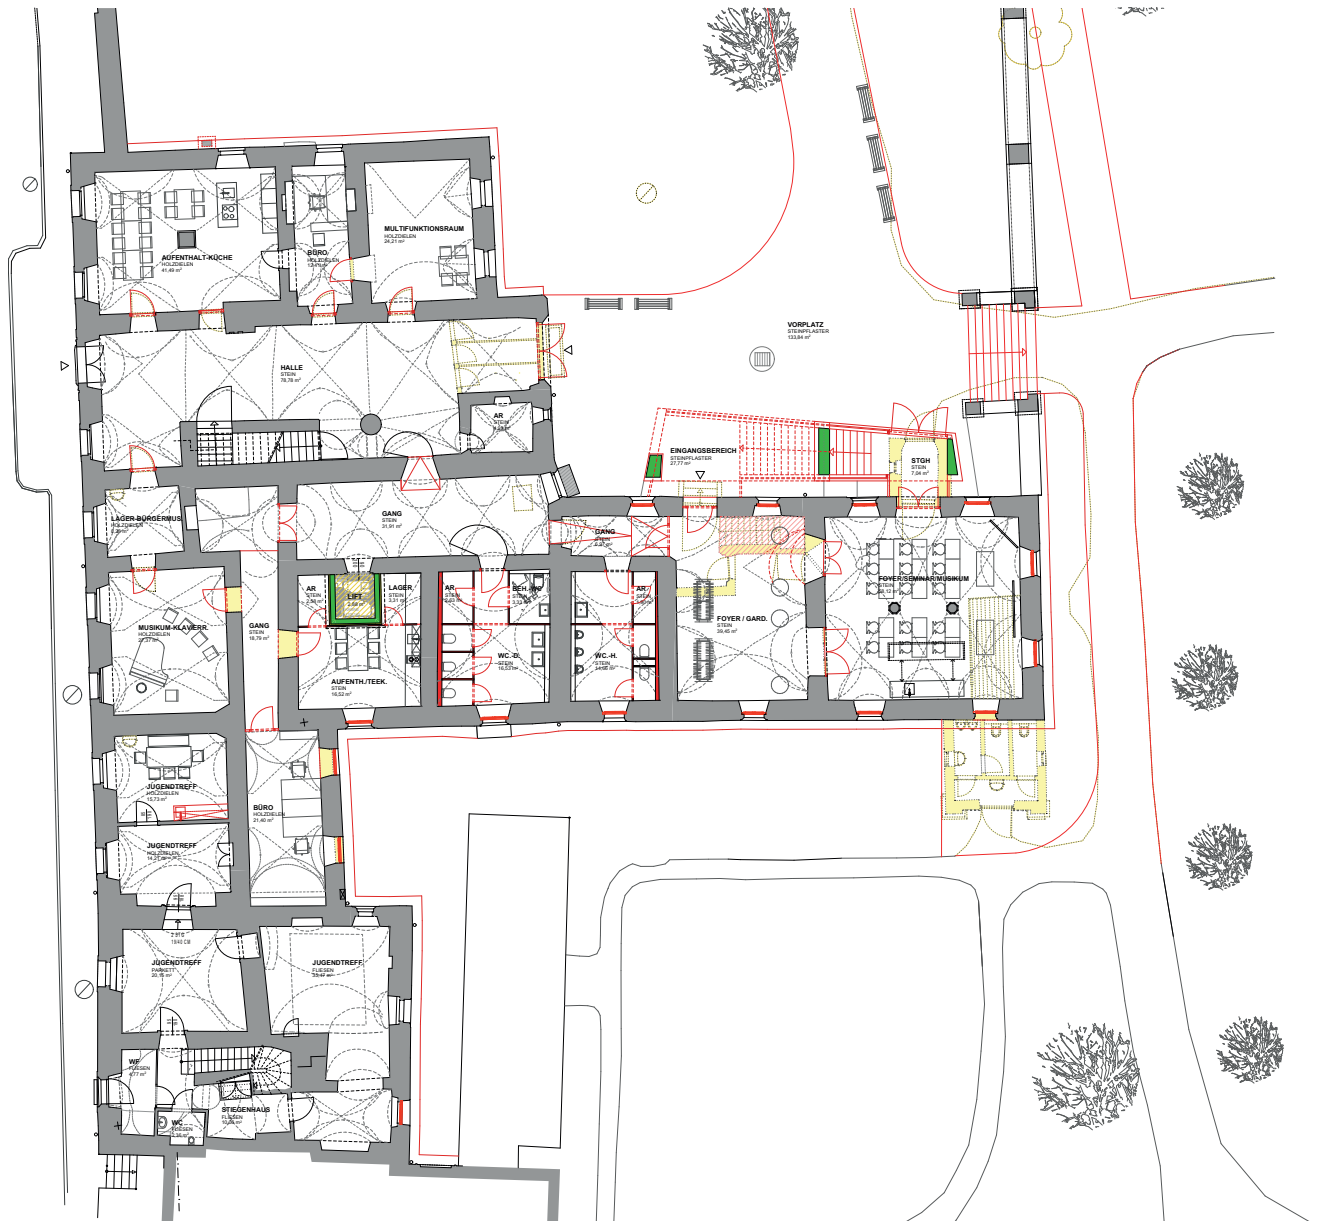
Grundriss Erdgeschoss, Schloss Kuenburg, Tamsweg, Ausschnitt
